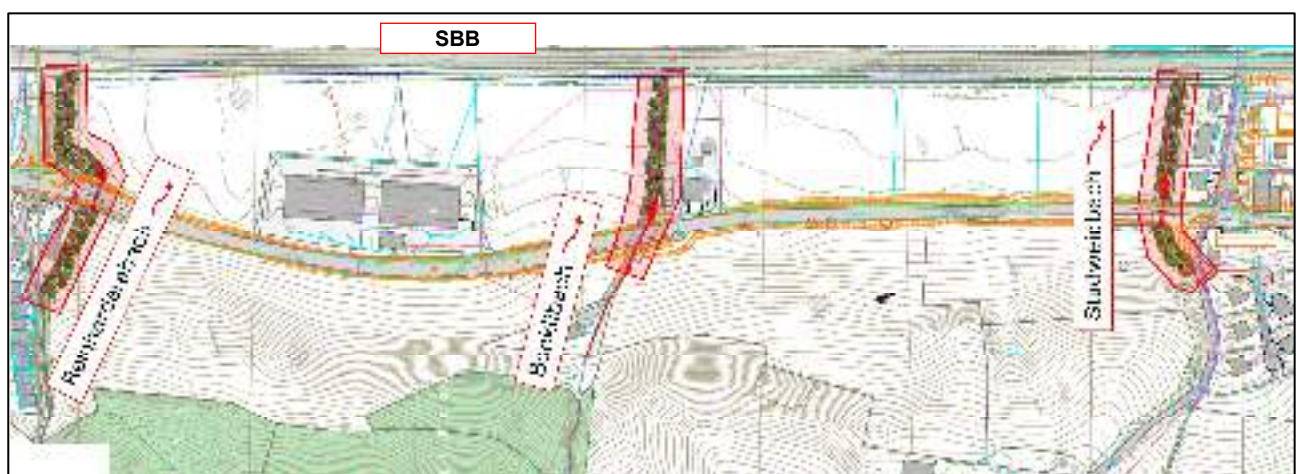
Situationsplan mit den drei Teilprojekten. Ein detaillierterer Plan findet sich in der Beilage.
